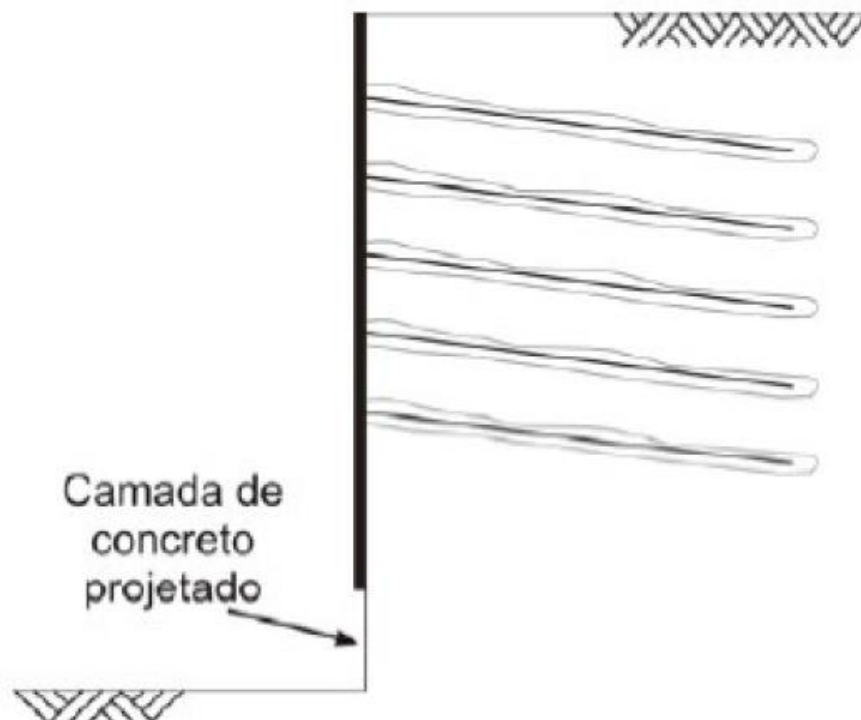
Aplicação de concreto projetado de proteção (Clouterre,1991).
